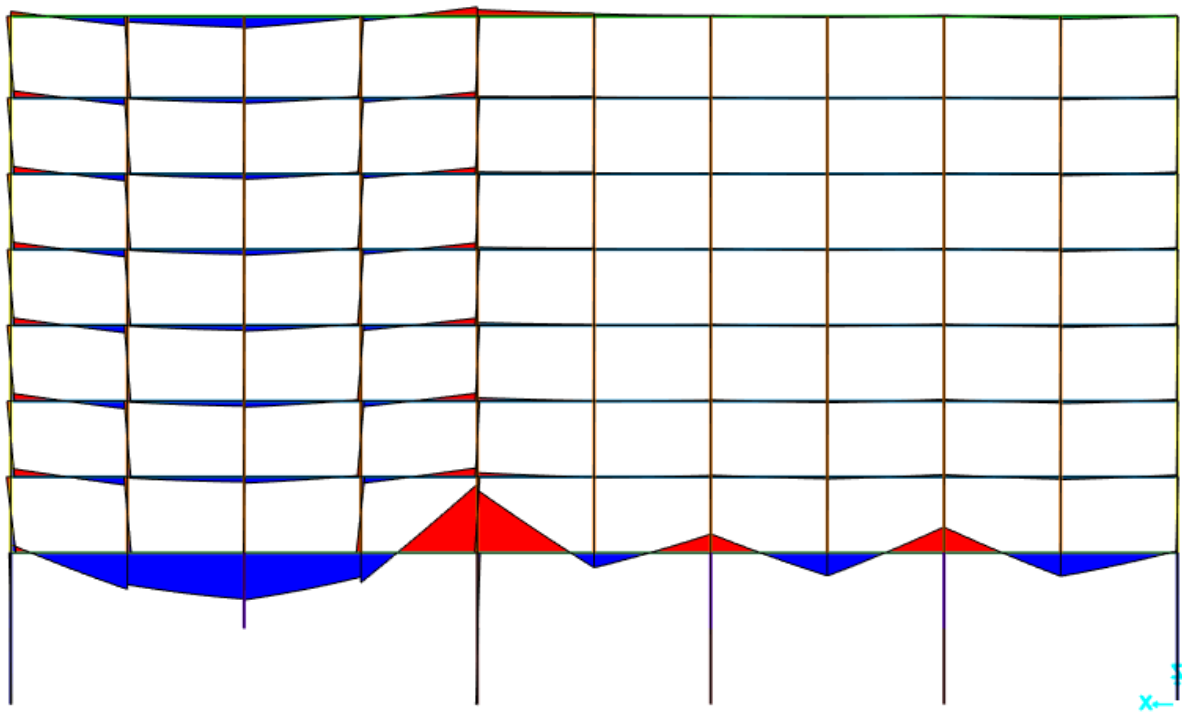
Diagrama de momentos flectores en la fachada norte tras fallar la columna G24.
